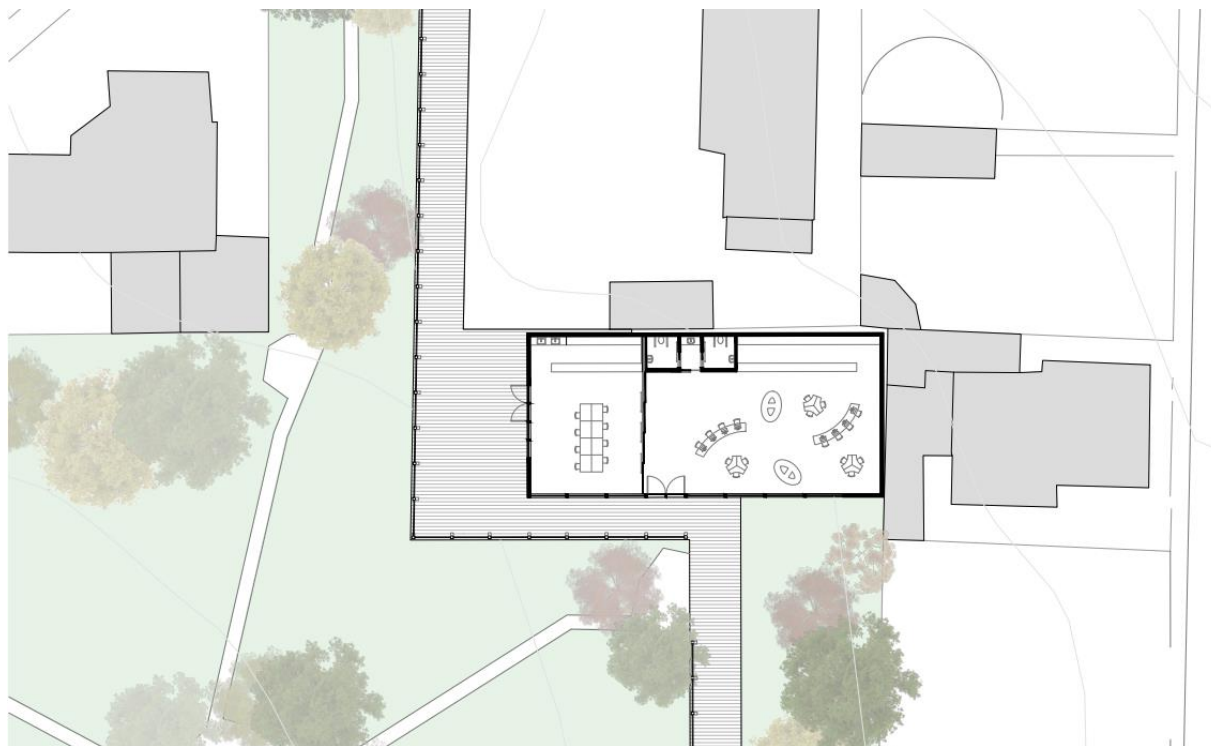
Planta Edifício 1 (redução da escala 1/200)
